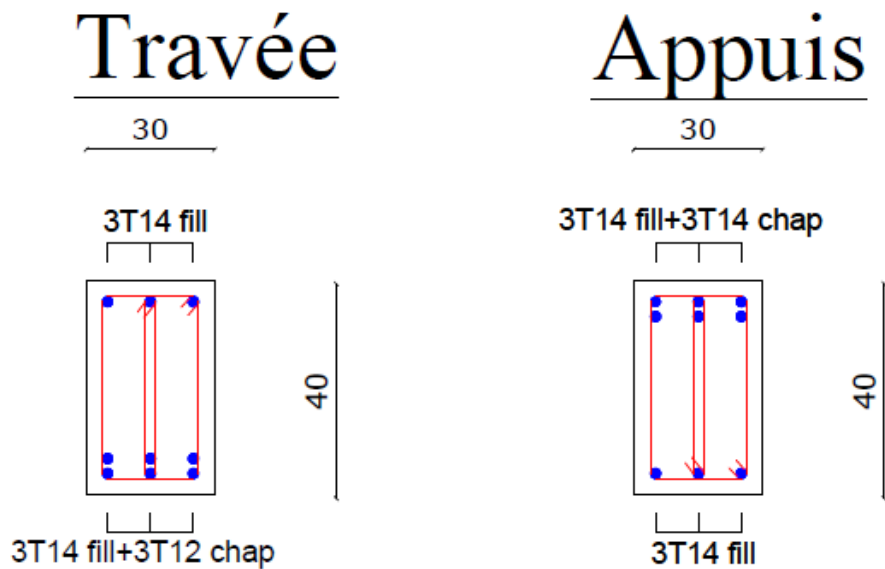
schéma de ferraillage de poutres porteuses.
